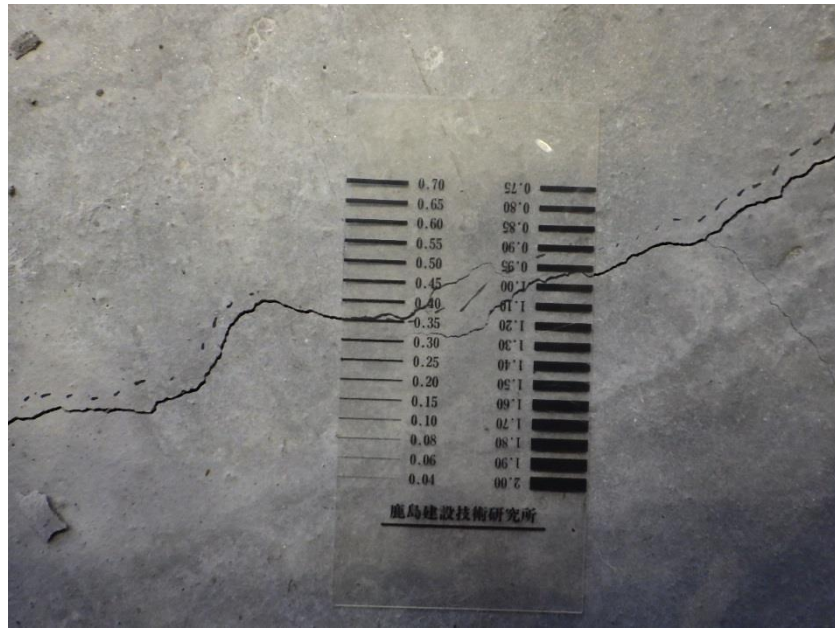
鉄筋コンクリート試験体ひび割れ発生状況 (①・②同時拡張後 2/3)
